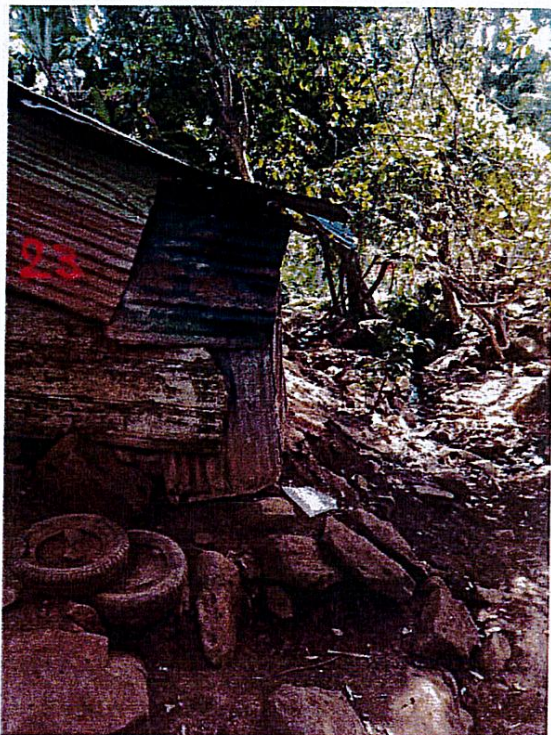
assemblage de morceaux de tôle ondulée rouillée à proximité de la rivière.
